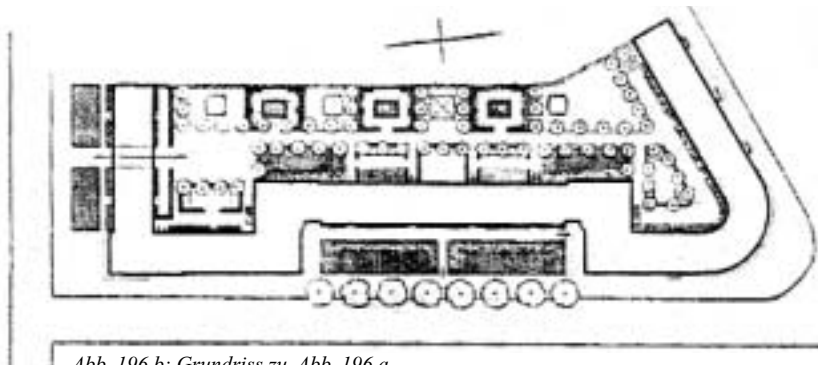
b: Grundriss zu Abb. 196 a
